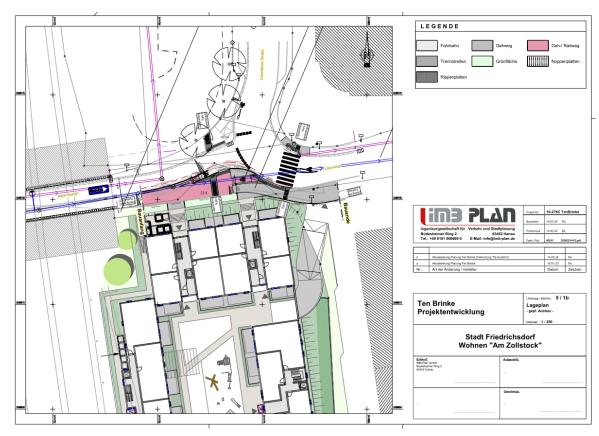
Lageplan, IMB Plan, Mai 2023
